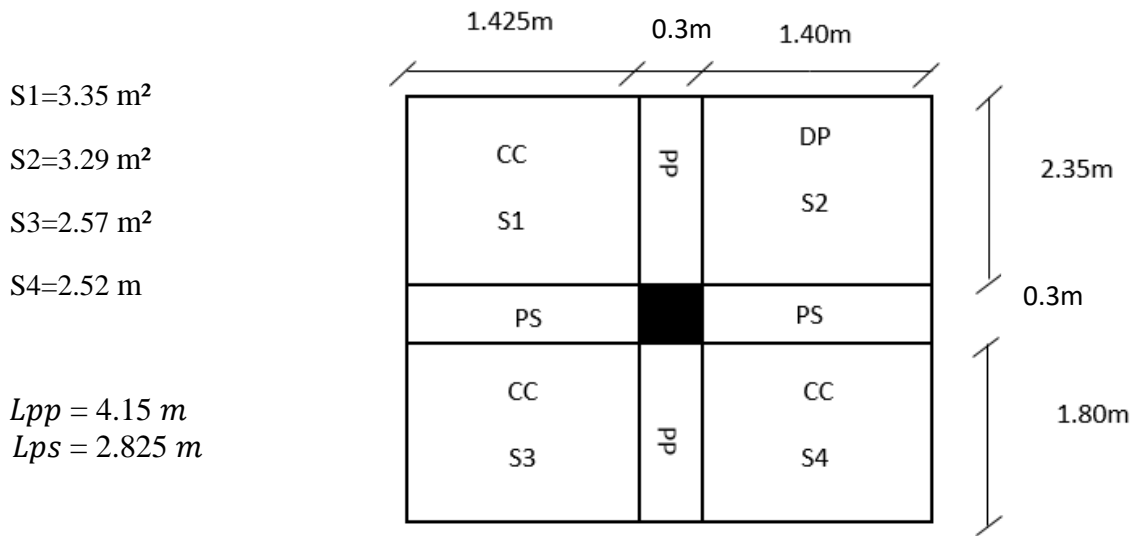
Surface afférente au niveau du plancher terrasse inaccessible.
